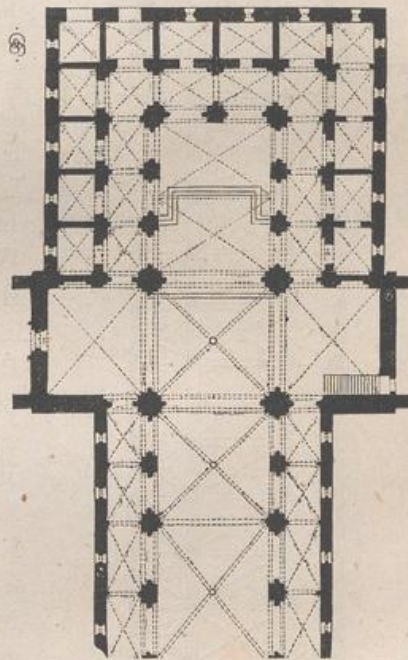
Kirche zu Riddagshausen. Grundriss.
